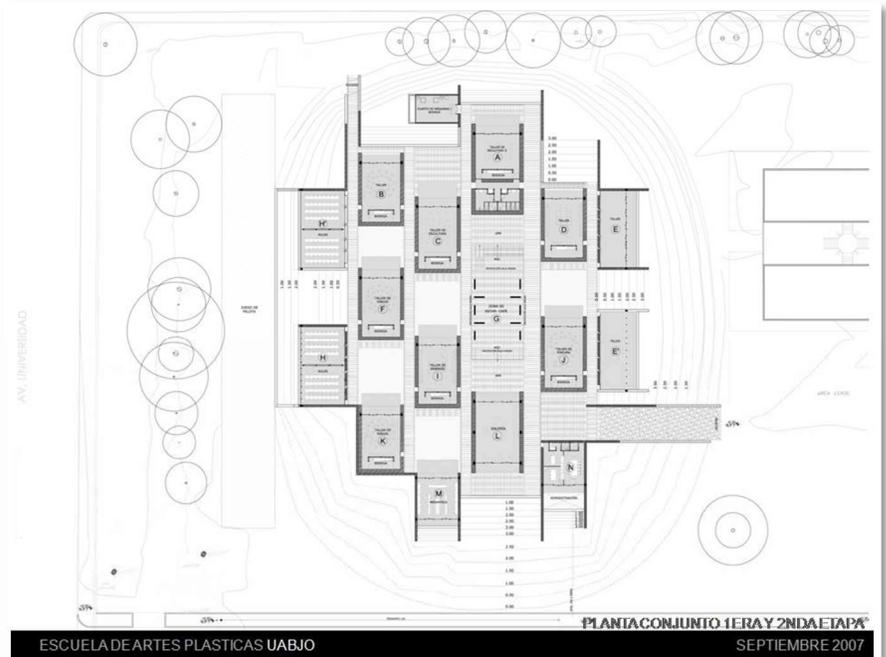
Plano Planta Arquitectónica de Conjunto de la Escuela de Artes Plásticas
